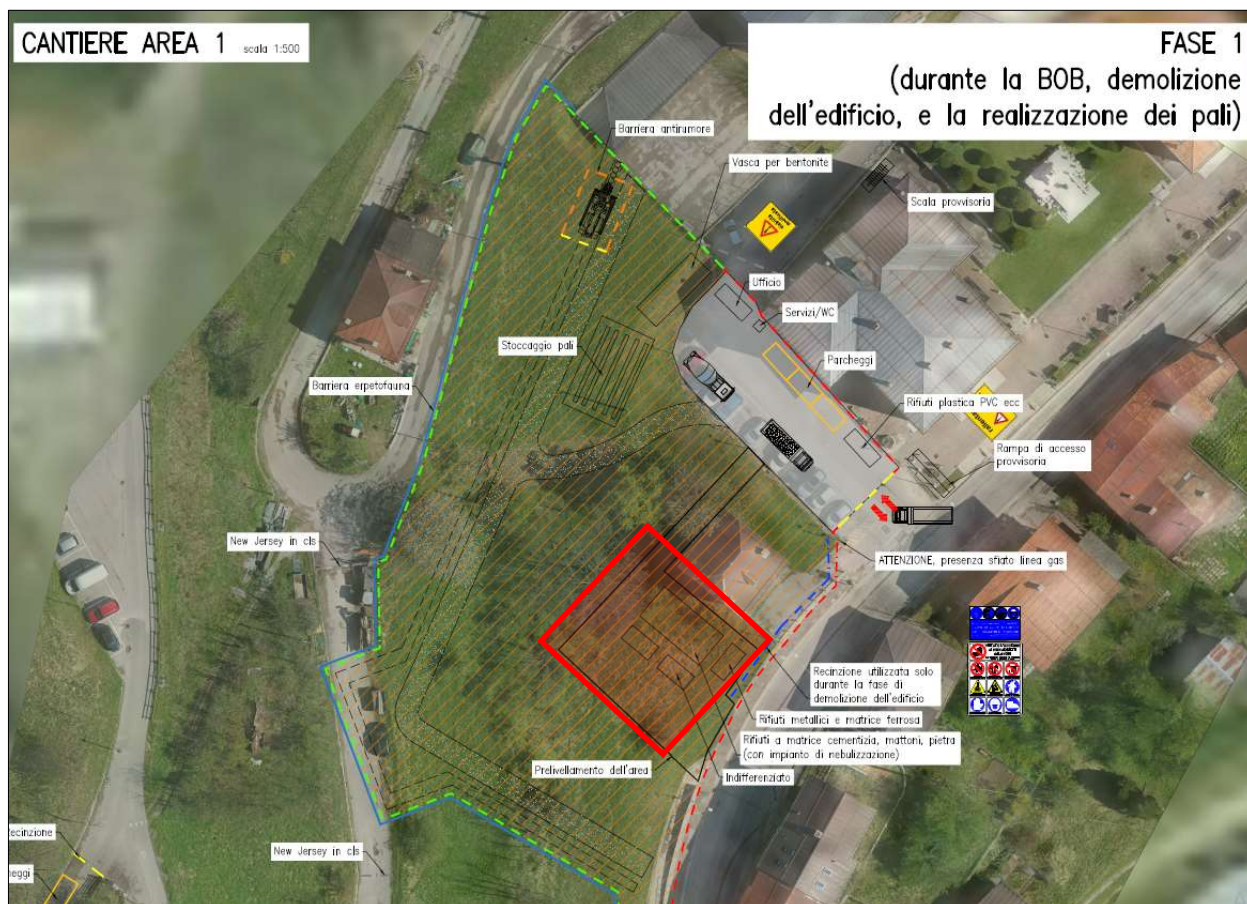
Pianta cantiere 1 – FASE 1 – area deposito temporaneo materiale demolizione edificio
